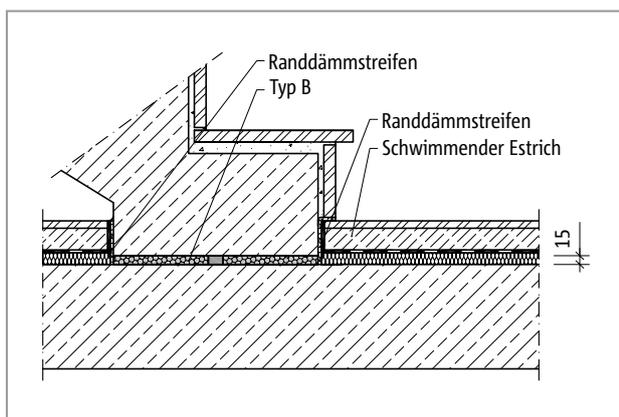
Schöck Tronsole® Typ B: Brandschutzausführung
